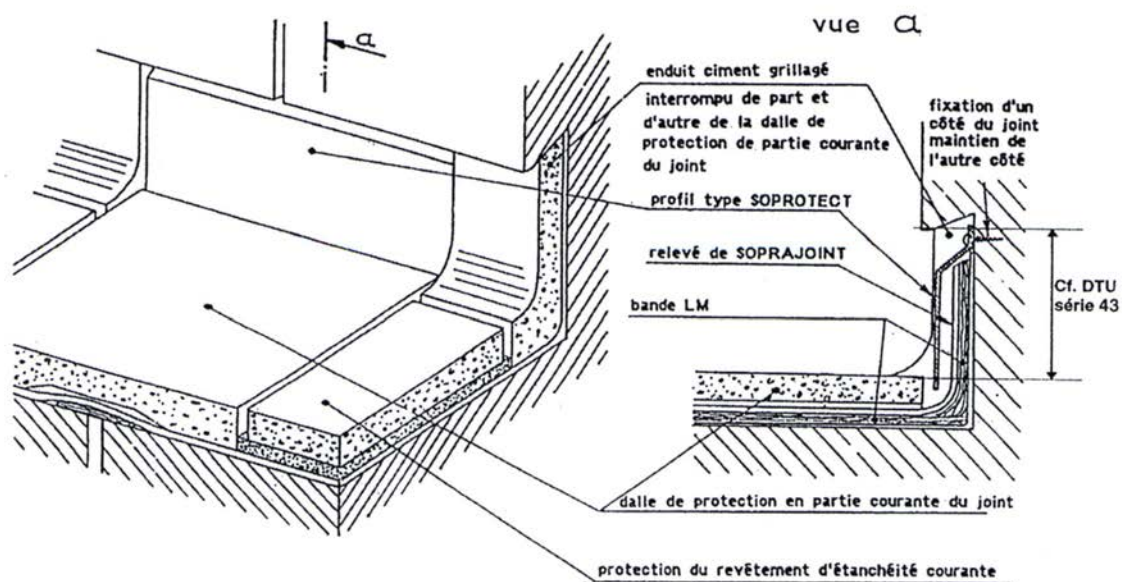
Protection verticale du joint par profil métallique (exemple)
